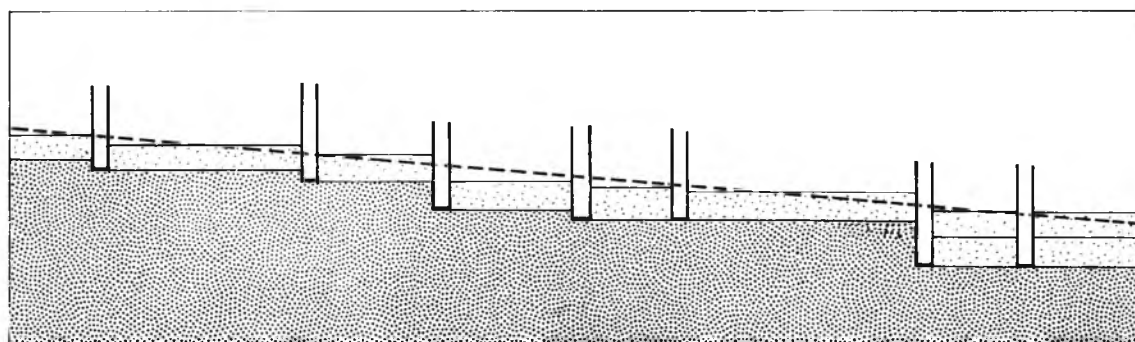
Schéma théorique de construction des murs en terrasse.
